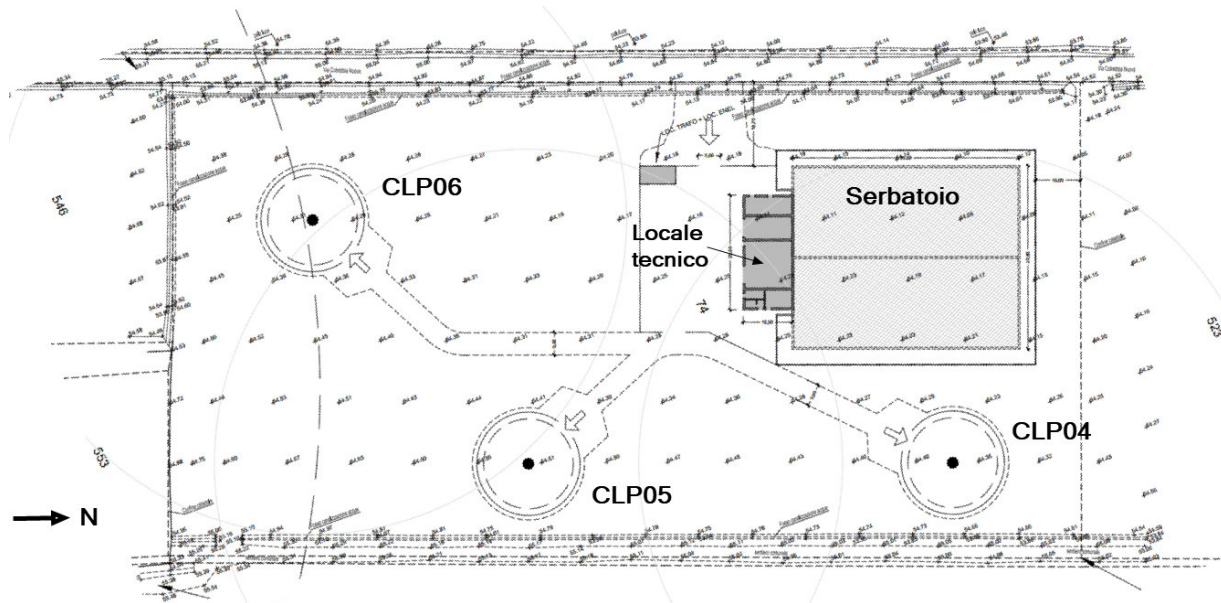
Estratto planimetria di progetto area nuovi pozzi
